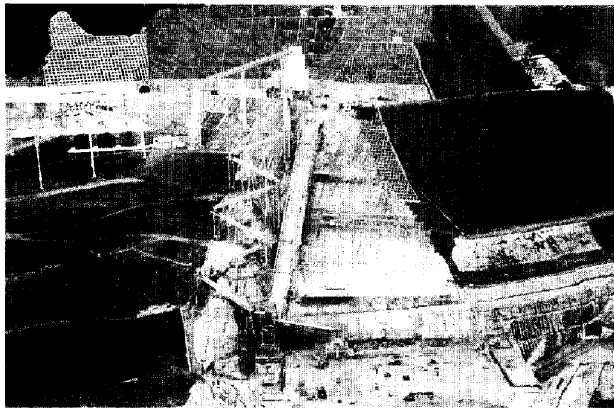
平成6年10月堤体状況 (ベルト延長=364.4m)
